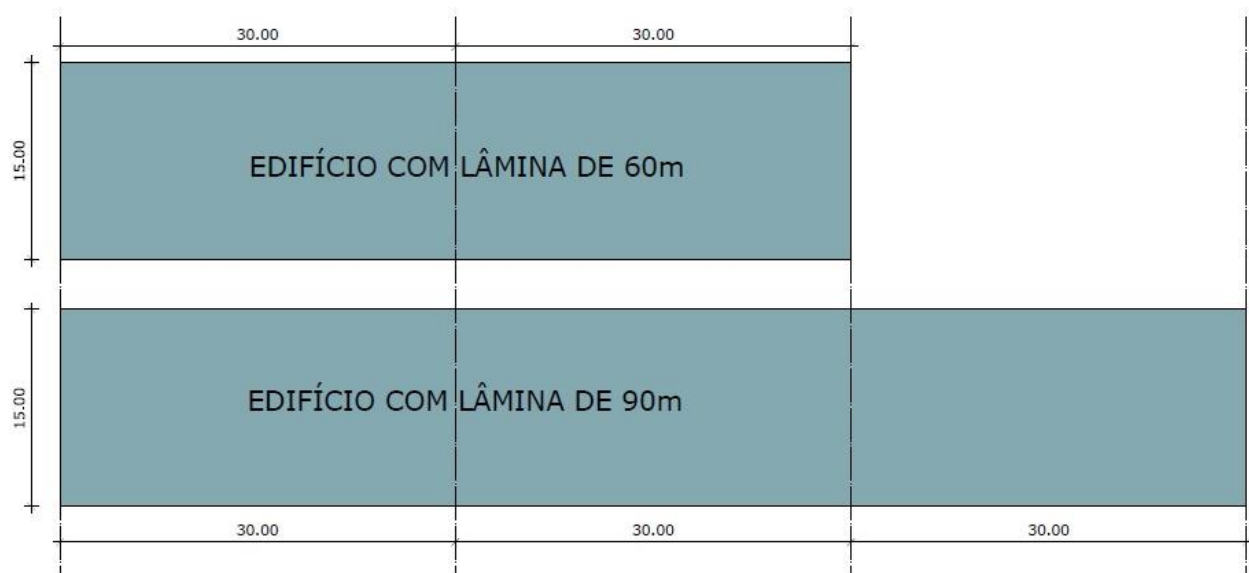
Ilustração esquemática da lâmina do edifício de comprimento modulado. Fonte: (da autora)
